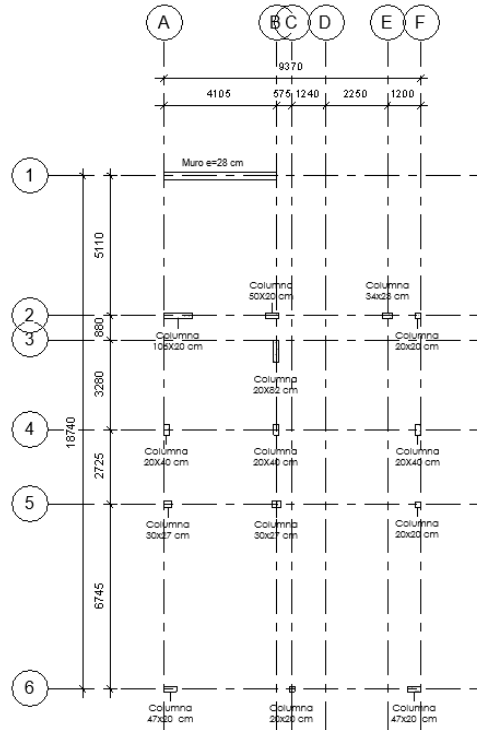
Ubicación de elementos verticales en la primera planta (Proaño G.,2021).
